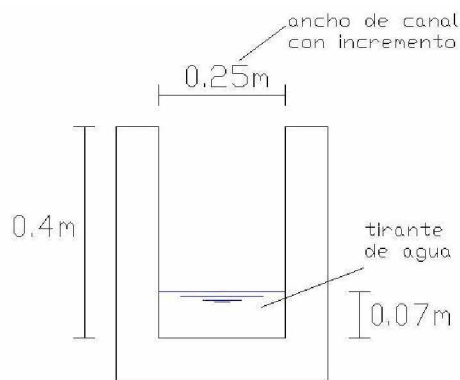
Sección del canal de rejillas para la Planta N°2
